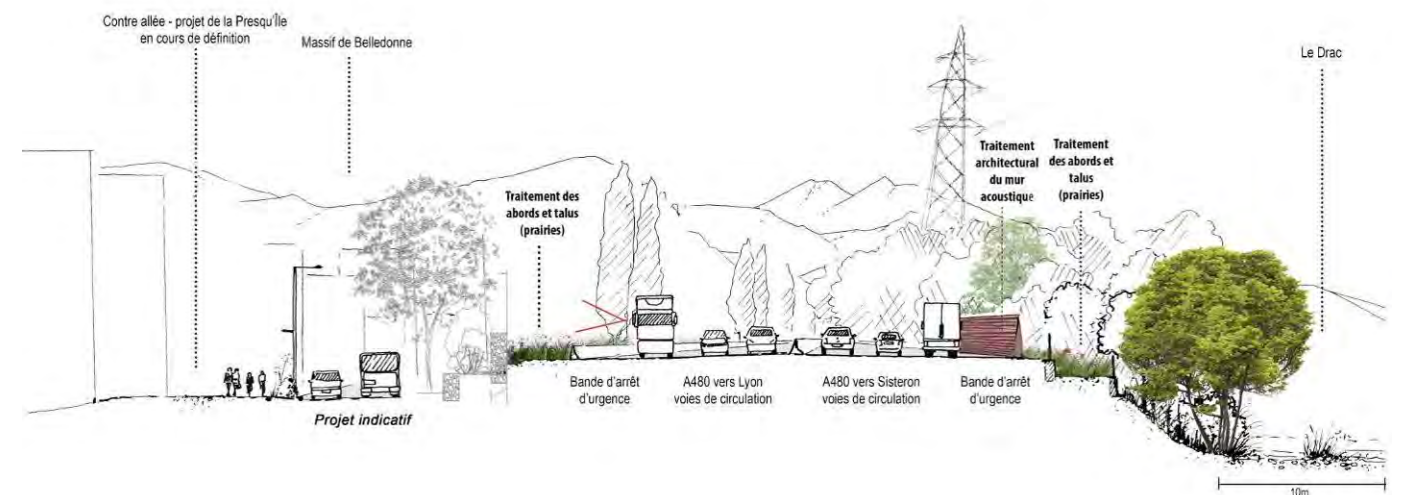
Profil en travers n° 2 - Secteur Presqu'île – profil état projeté (© Ingerop)
